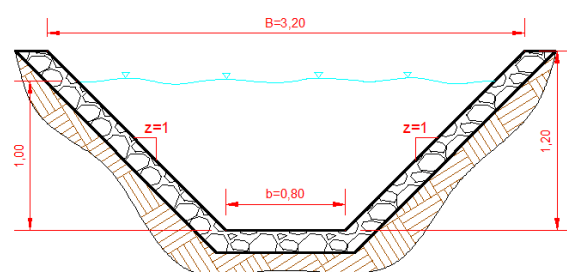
Esquema de canal propuesto en piedra trapezoidal en alternativa 3.
